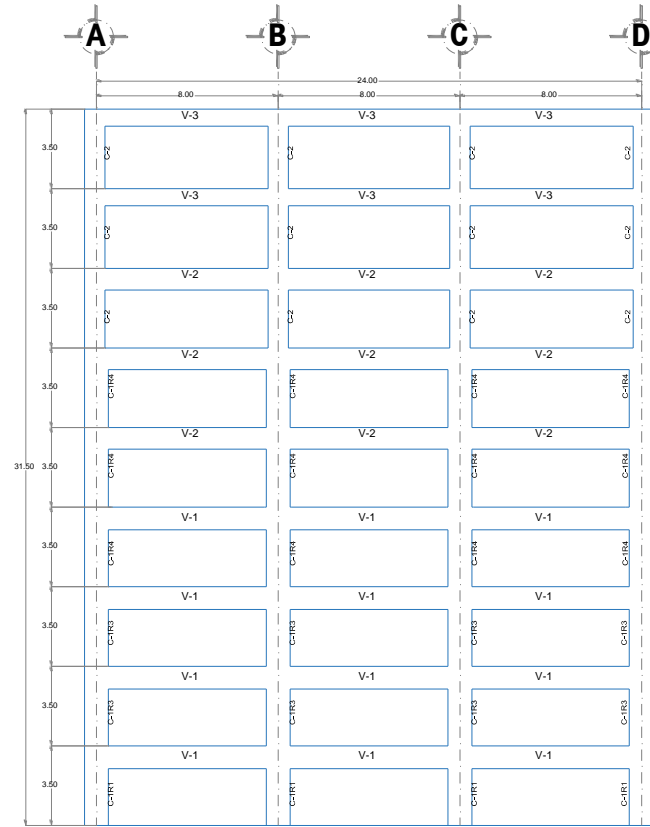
Alzado de armado de columnas y vigas de edificio de 6 niveles con base a la hipótesis de las NTCC-17.
